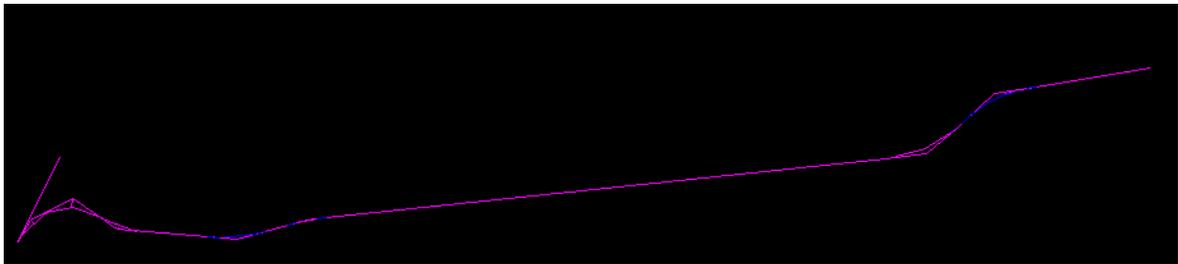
Planta de los cinco kilómetros del ramal Cumanayagua.
